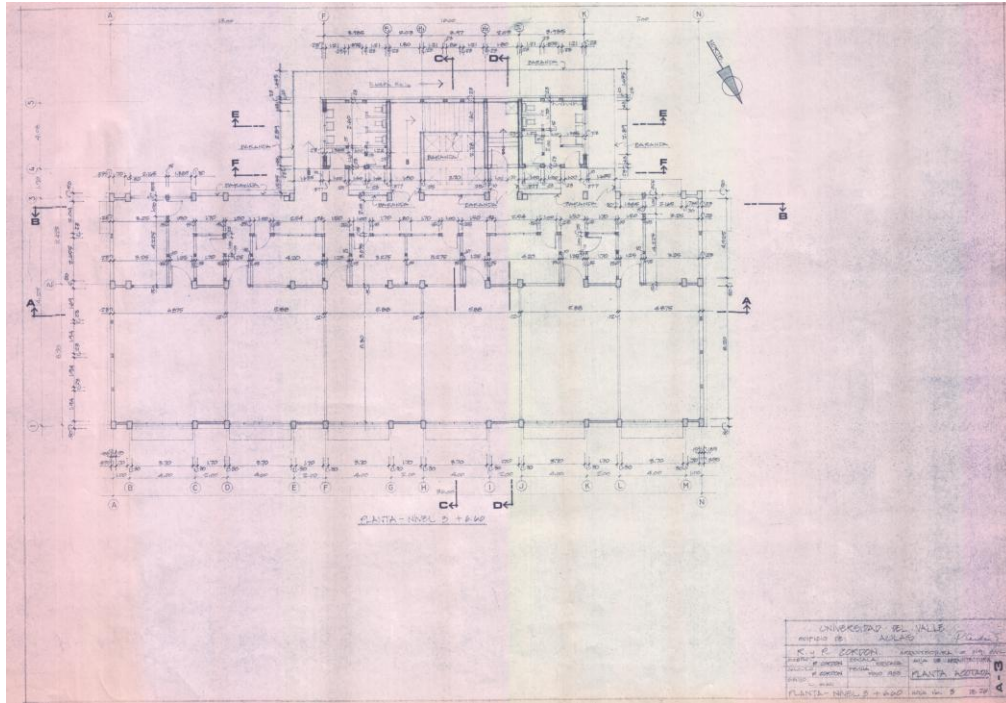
Plano de planta nivel 3 Edificio A en Universidad del Valle de Guatemala, Campus Central. Por R. y P. Córdón Arquitectura e Ing. Civil (1983)
